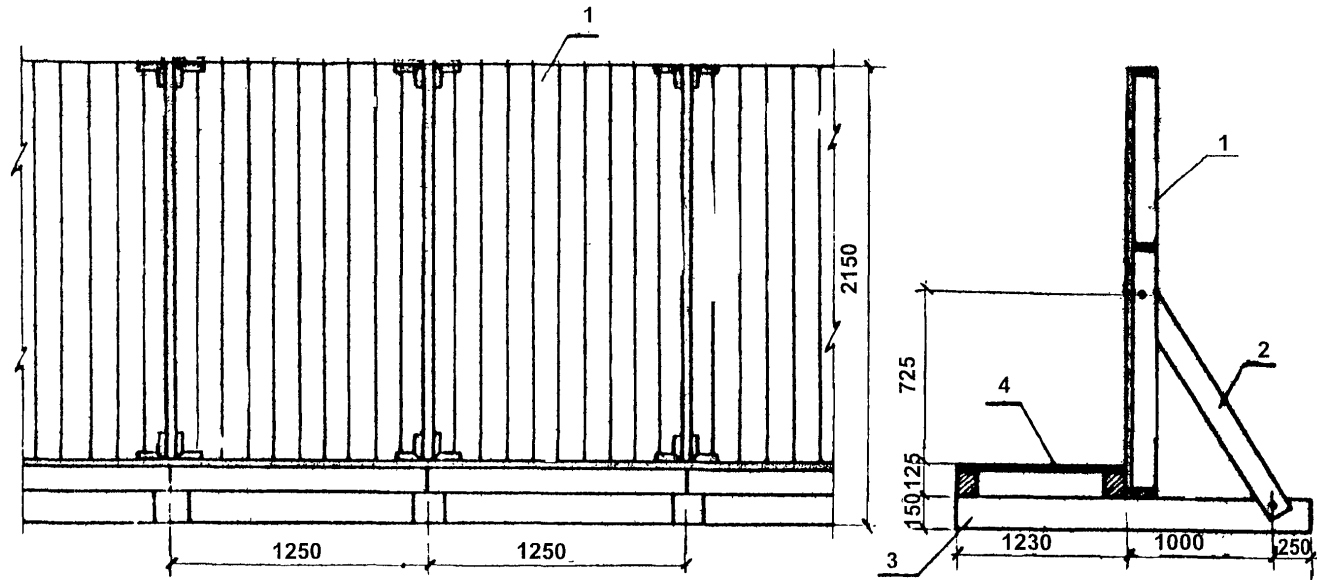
Сборно-разборное, бесстоечное ограждение на железобетонных лежнях с тротуарными щитами:
